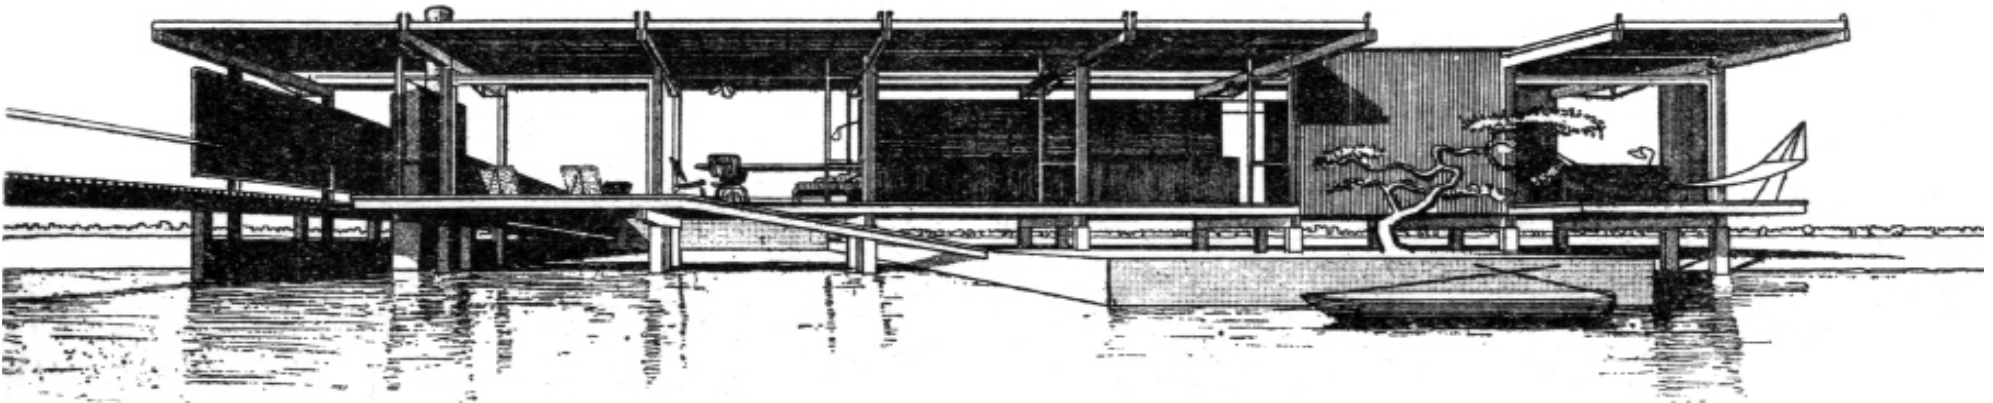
Perspectiva del alzado principal de la Finney House. Paul Rudolph Heritage Foundation
